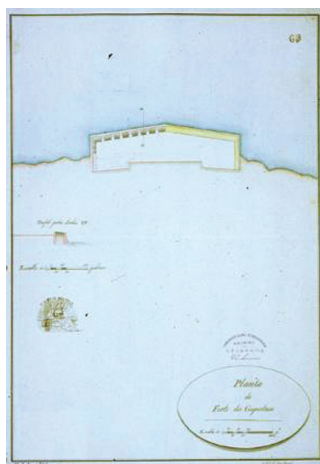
Planta da bateria da Jiquitaia, desenhada pelo ten. Teixeira Leal.
